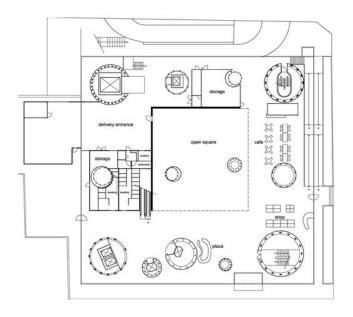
Planta 1er. Nivel, Mediateca de Sendai.
